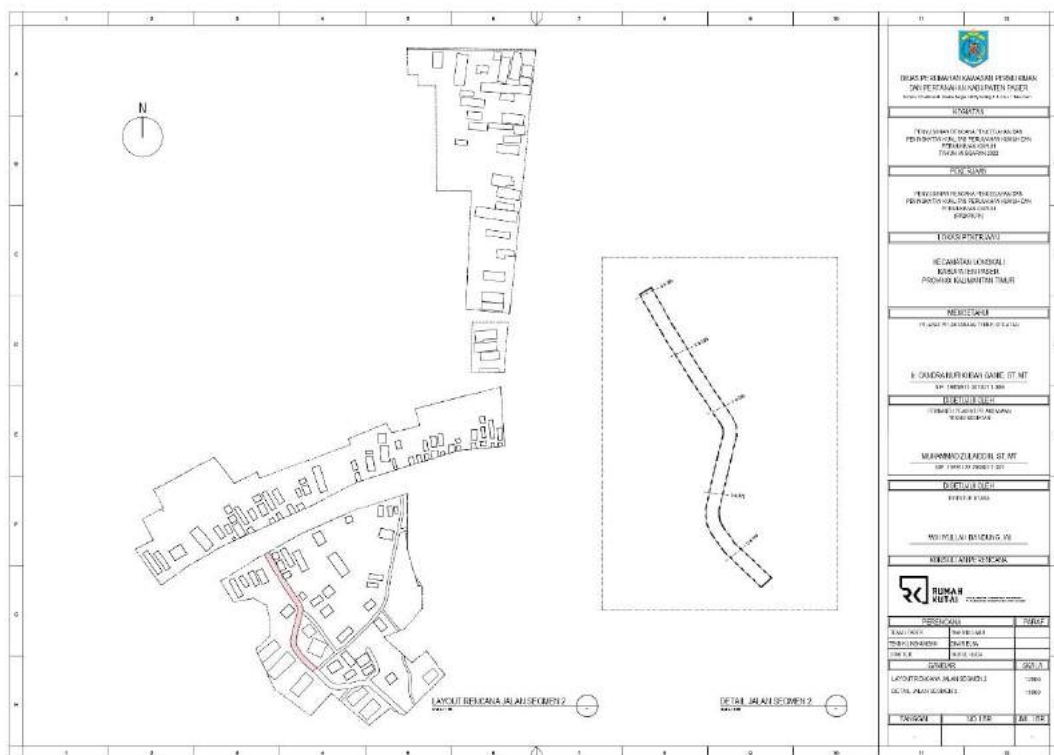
98 Konsep Recana Detail Jalan Lebar 3m RT.14
